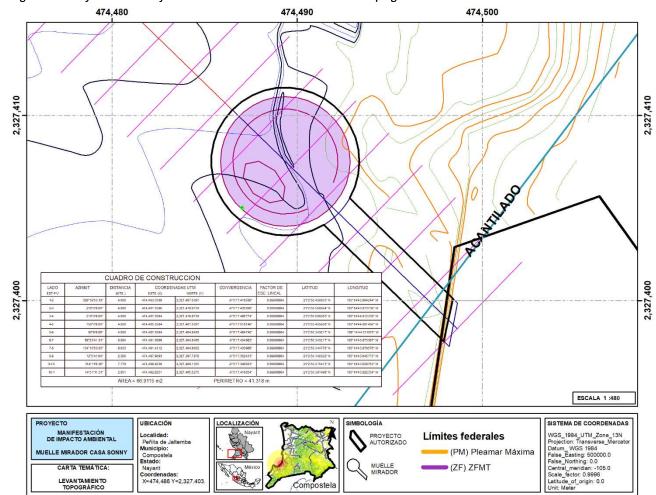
Proyecto de conjunto de acuerdo al levantamiento topográfico.
